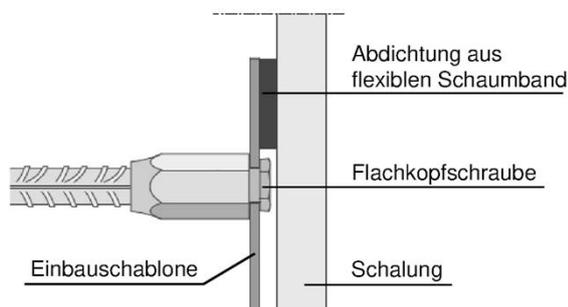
Montageprinzip für vertiefte Anschlussebene: Einbauschablone mit Hohlraum zur Schalung
